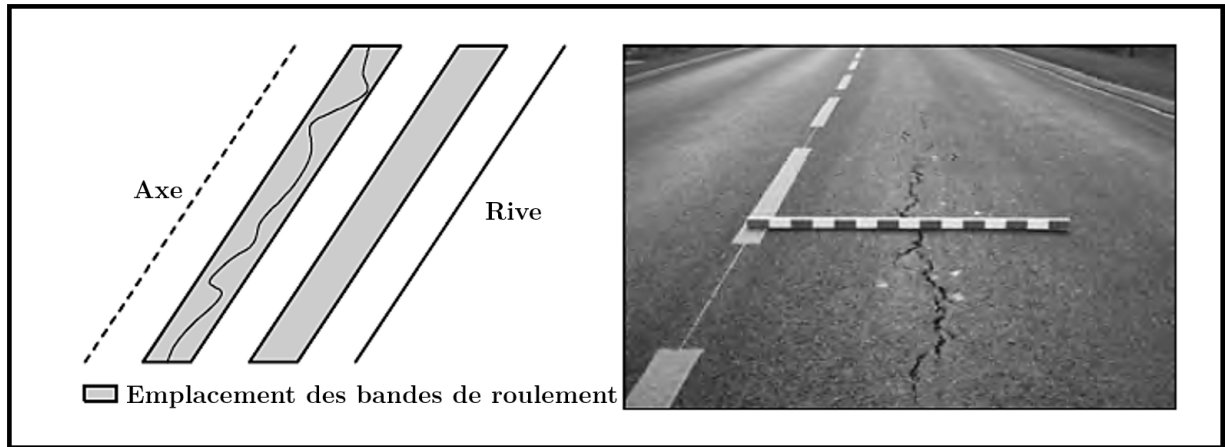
Schéma d'une fissuration longitudinale dans les bandes de roulement [Di Benedetto and Corté 2005]
